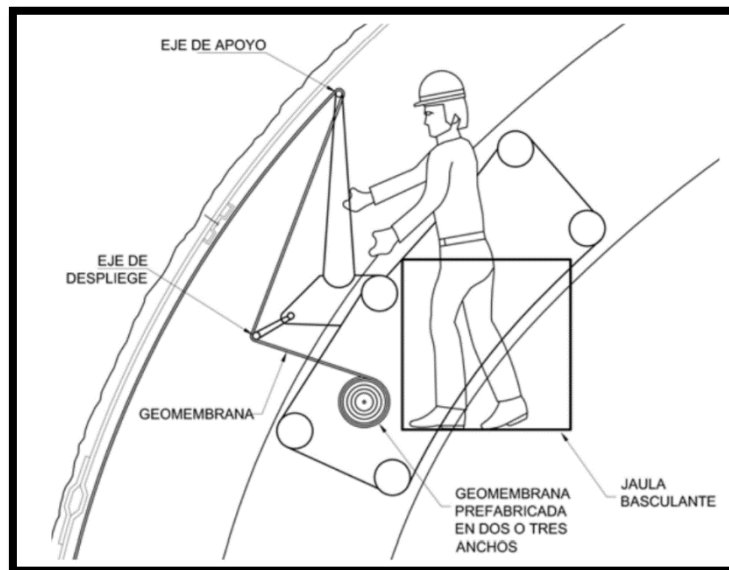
Esquema tipo de andamiaje para colocación automática
